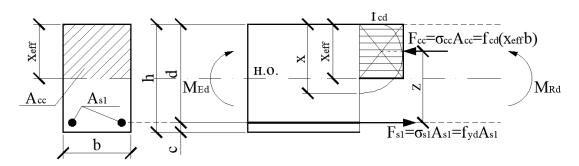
Расчетное сечение балки с одиночным армированием
